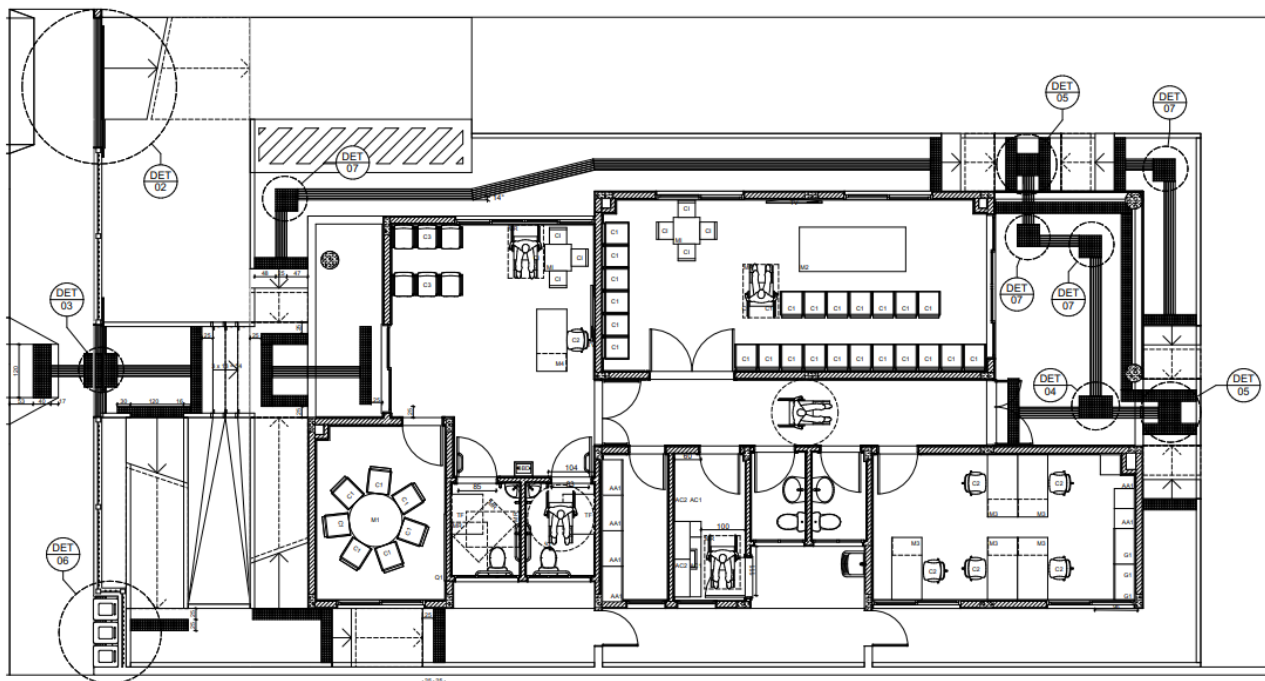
Planta de paginação de piso correspondente a Prancha 04 do Projeto Arquitetônico
